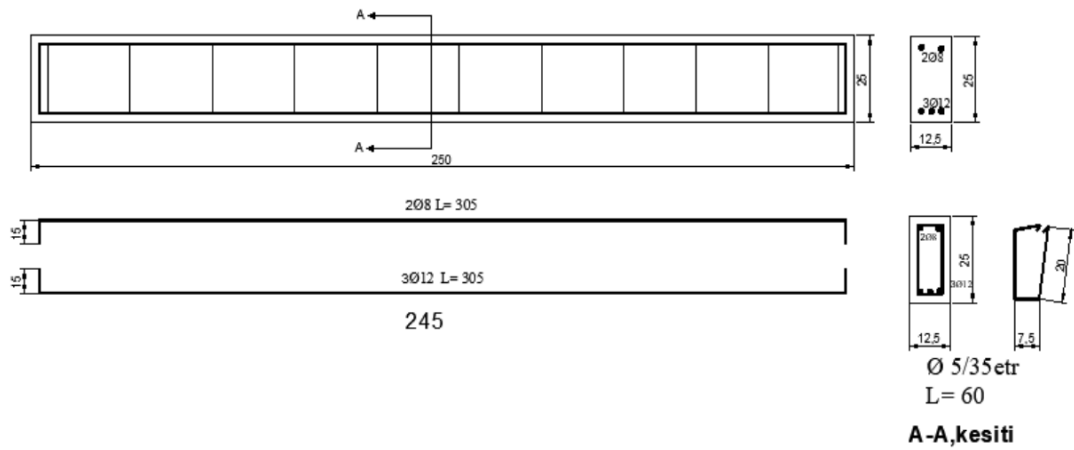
Betonarme kirişler deney elemanlarının boyutları (ölçüleri cm'dir) ve a/d oranı (Doğangün, 2008)
